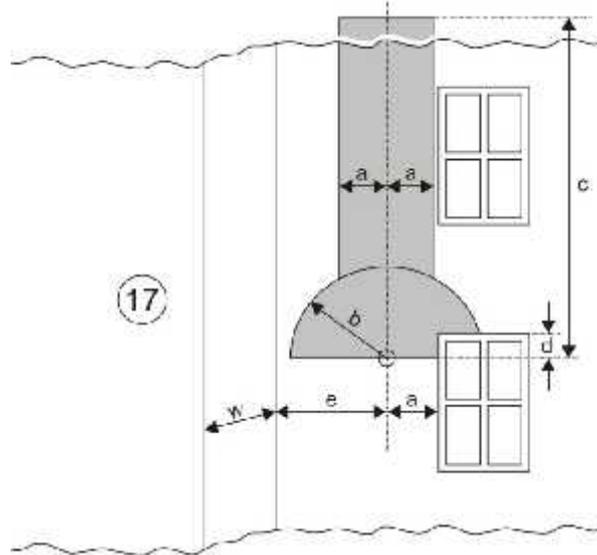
Débouché du terminal en façade à proximité d'un angle - Pan de façade adjacent sans ouverture
